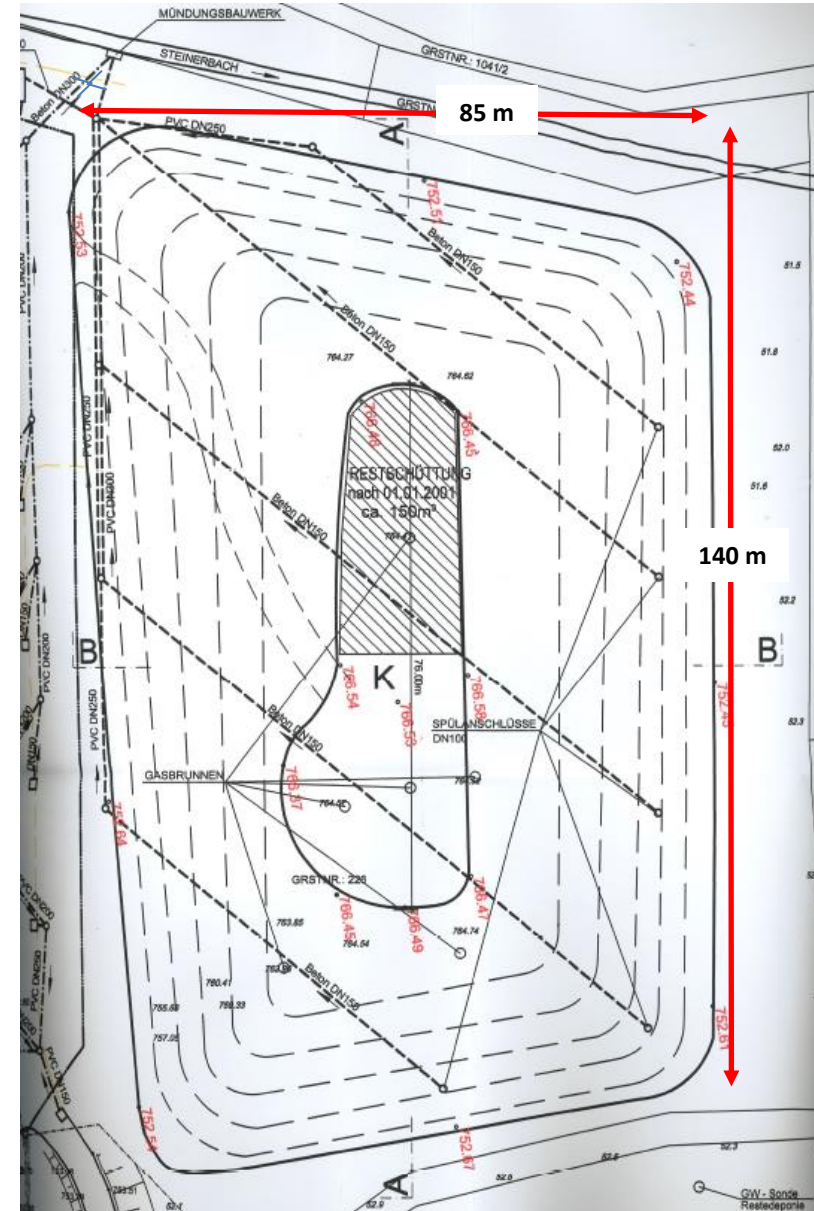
Grundriss / Hauptabmessungen der Deponie. Quelle wie Abb. 14
